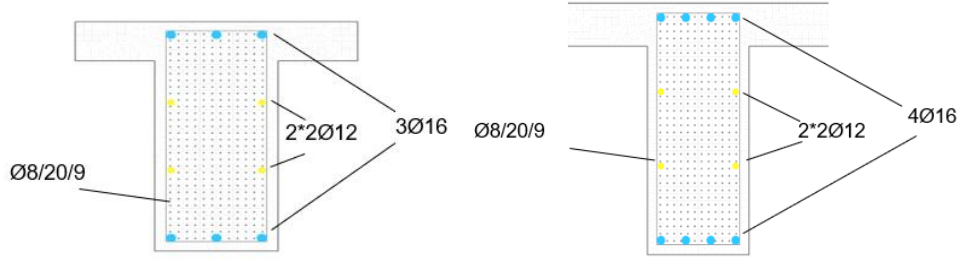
Okul binası K123-K124 ve K148-K149 kiriş kesiti ve donatı detayı
